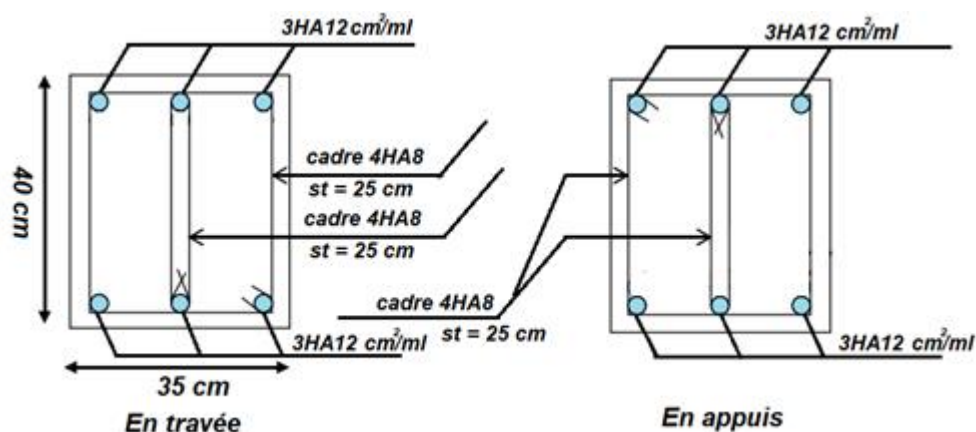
Schéma ferraillage de la poutre chaînage.
